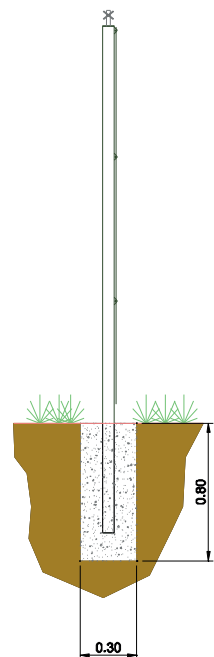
DETAILS - ÉLÉVATIONS DU PORTAIL D'ENTRÉE ET DE LA CLÔTURE - échelle 1/40e
